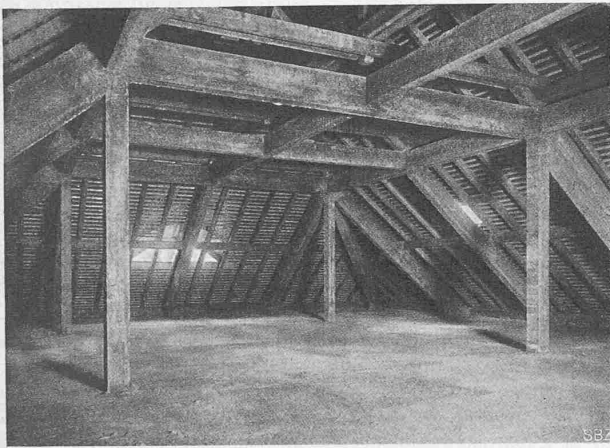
Innenansicht der Dachkonstruktion, Magazin II.
